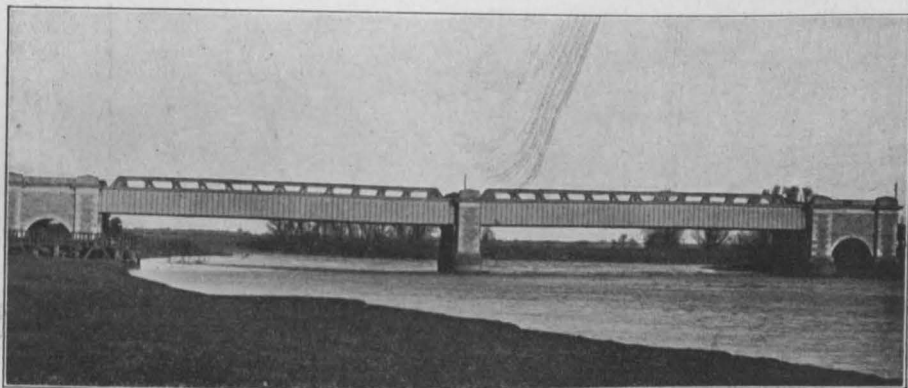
Die Torkseybrücke nach erfolgtem Umbau. 1897.
